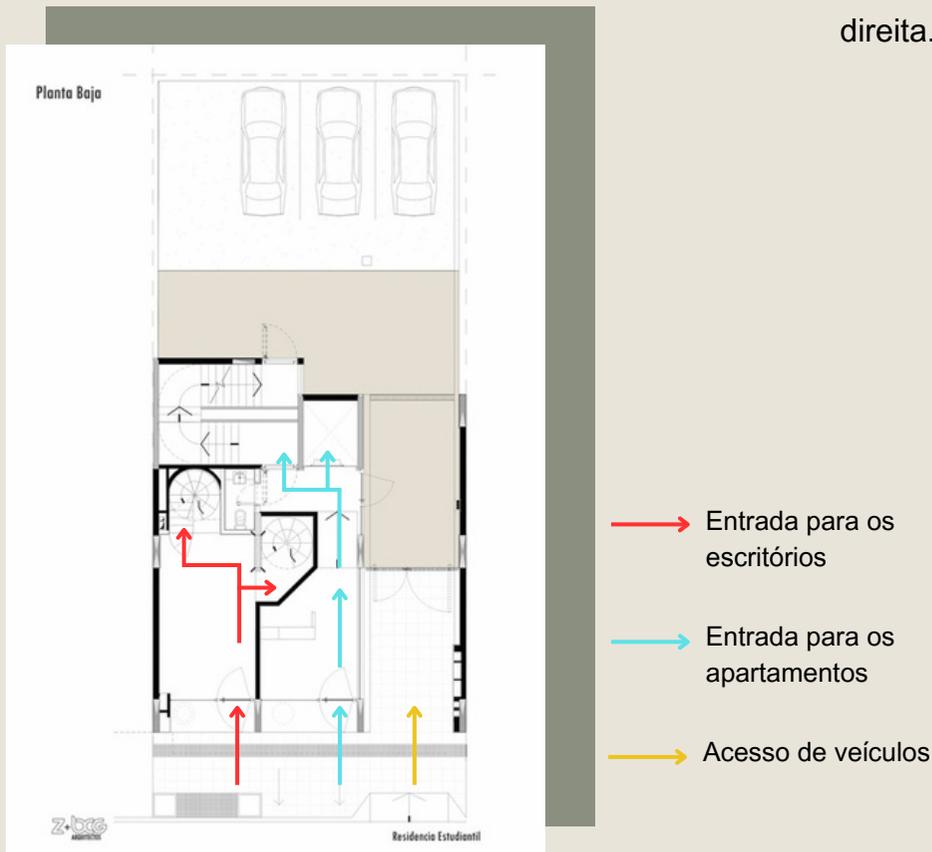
Planta Baixa do Térreo. Fonte: Archdaily (Editado pela autora)
